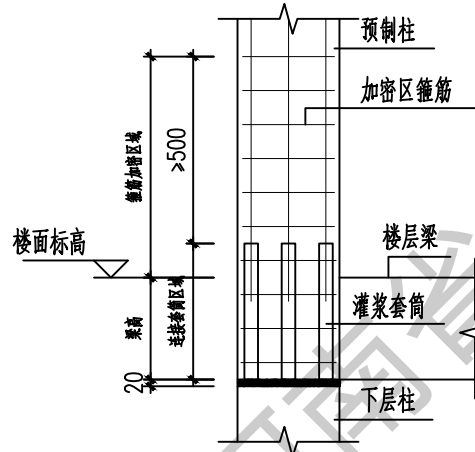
一层预制套筒灌浆连接预制柱柱底箍筋加密构造
